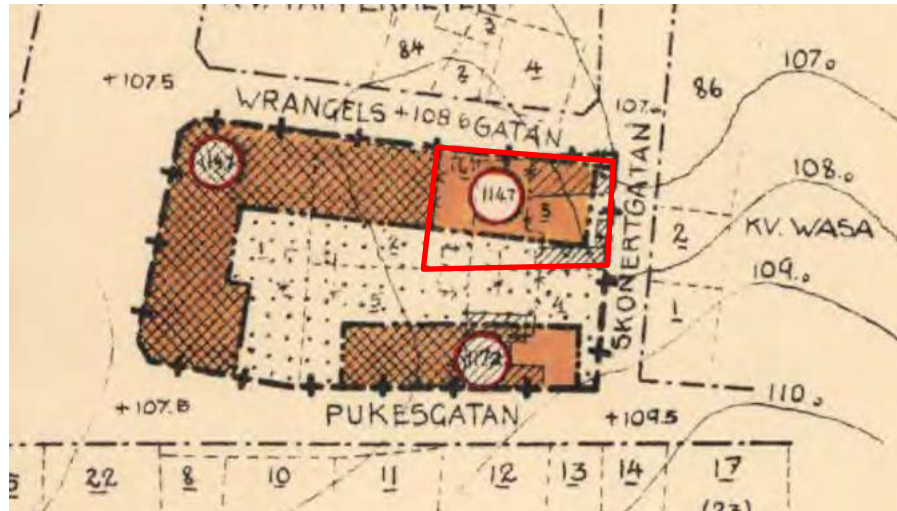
Utdrag ur gällande/underliggande detaljplan. Ändring av detaljplan omfattar del av gällande detaljplan, fastigheten Svarta Örn 7, markerad med röd linje.
